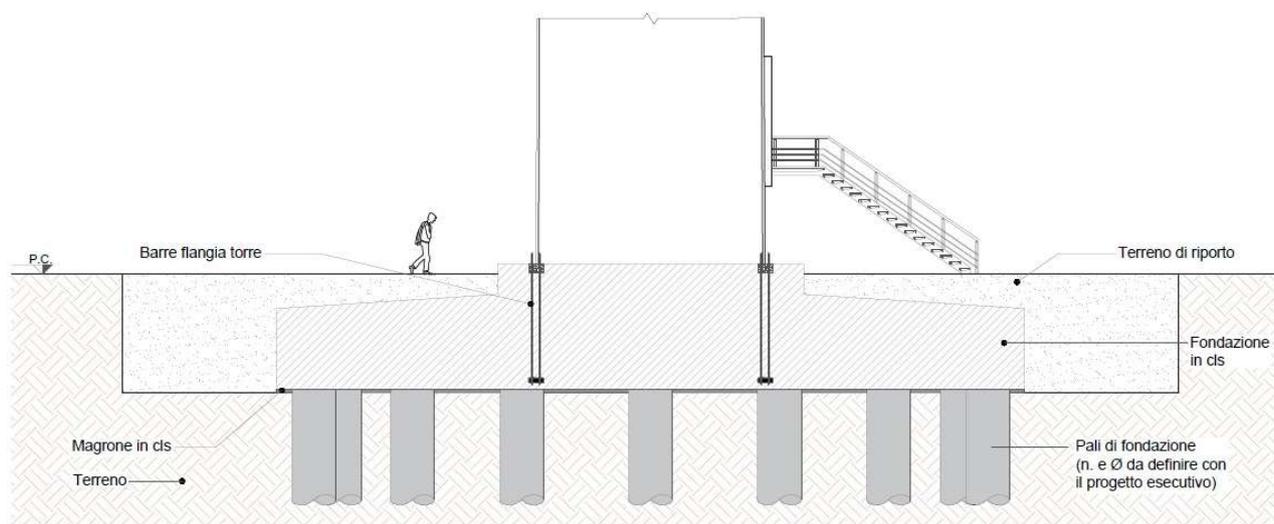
Sezione tipo aerogeneratore - piastra di fondazione su pali
